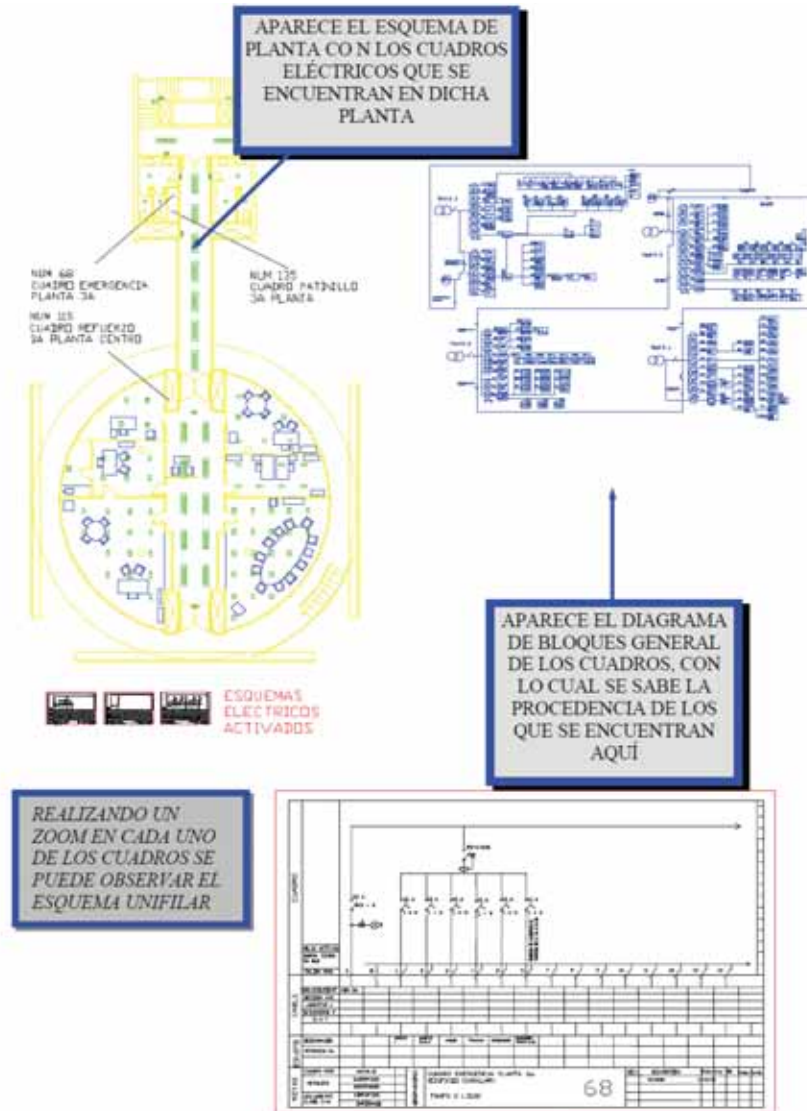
Detalle de tratamiento de la planimetría mediante diagramas de bloques orientada a la posición en planta. Fuente: Elaboración propia.
